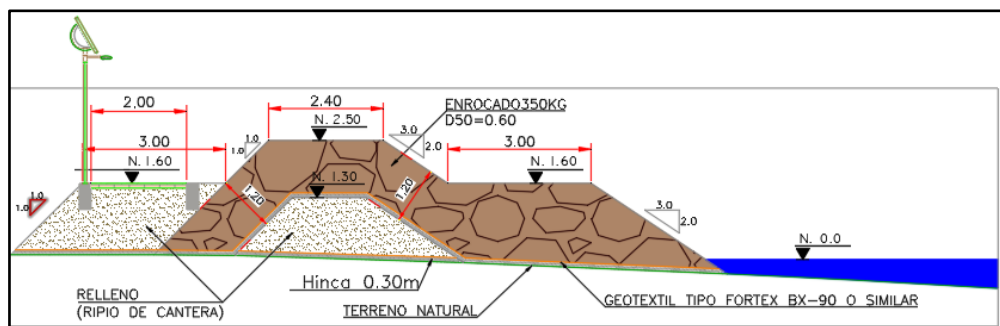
Sección tipo de la Infraestructura de la protección longitudinal.
